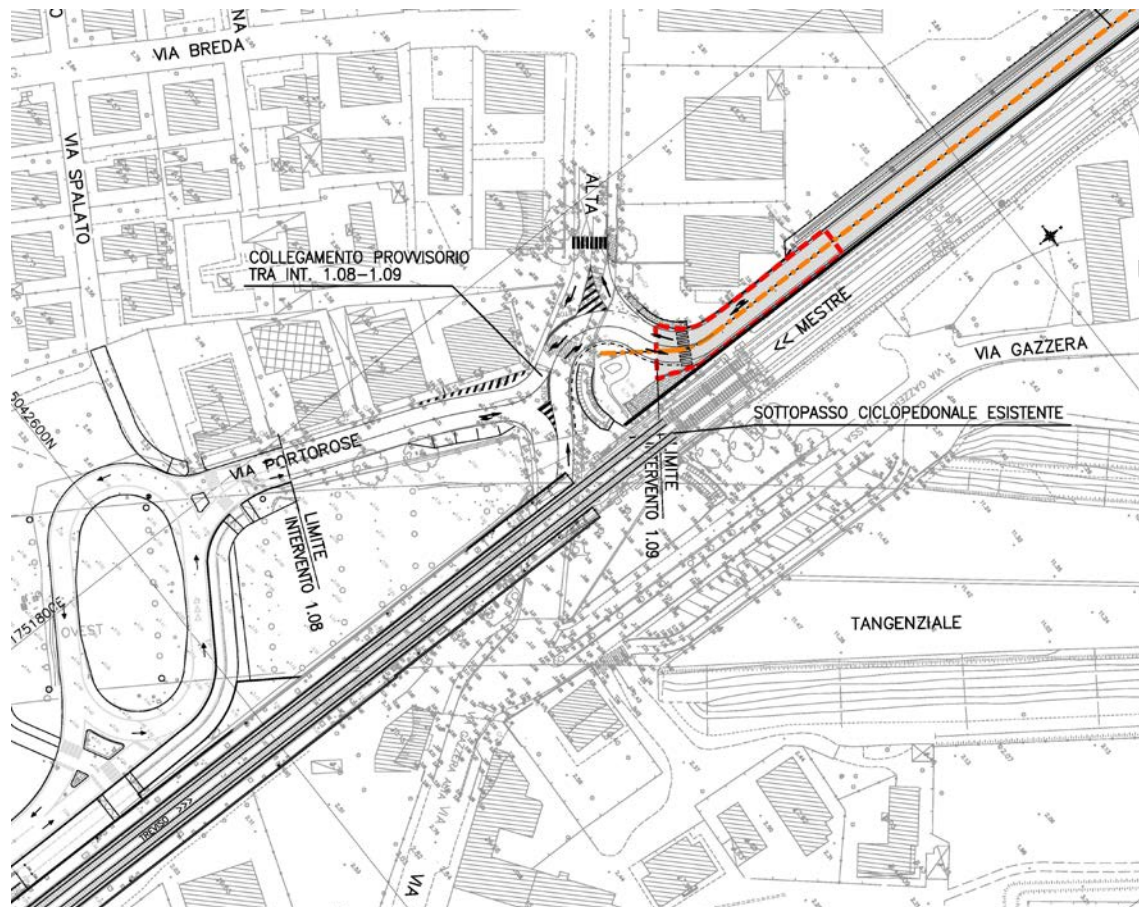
Planimetria collegamento provvisorio Via Gazzera Alta – Via Portorose
